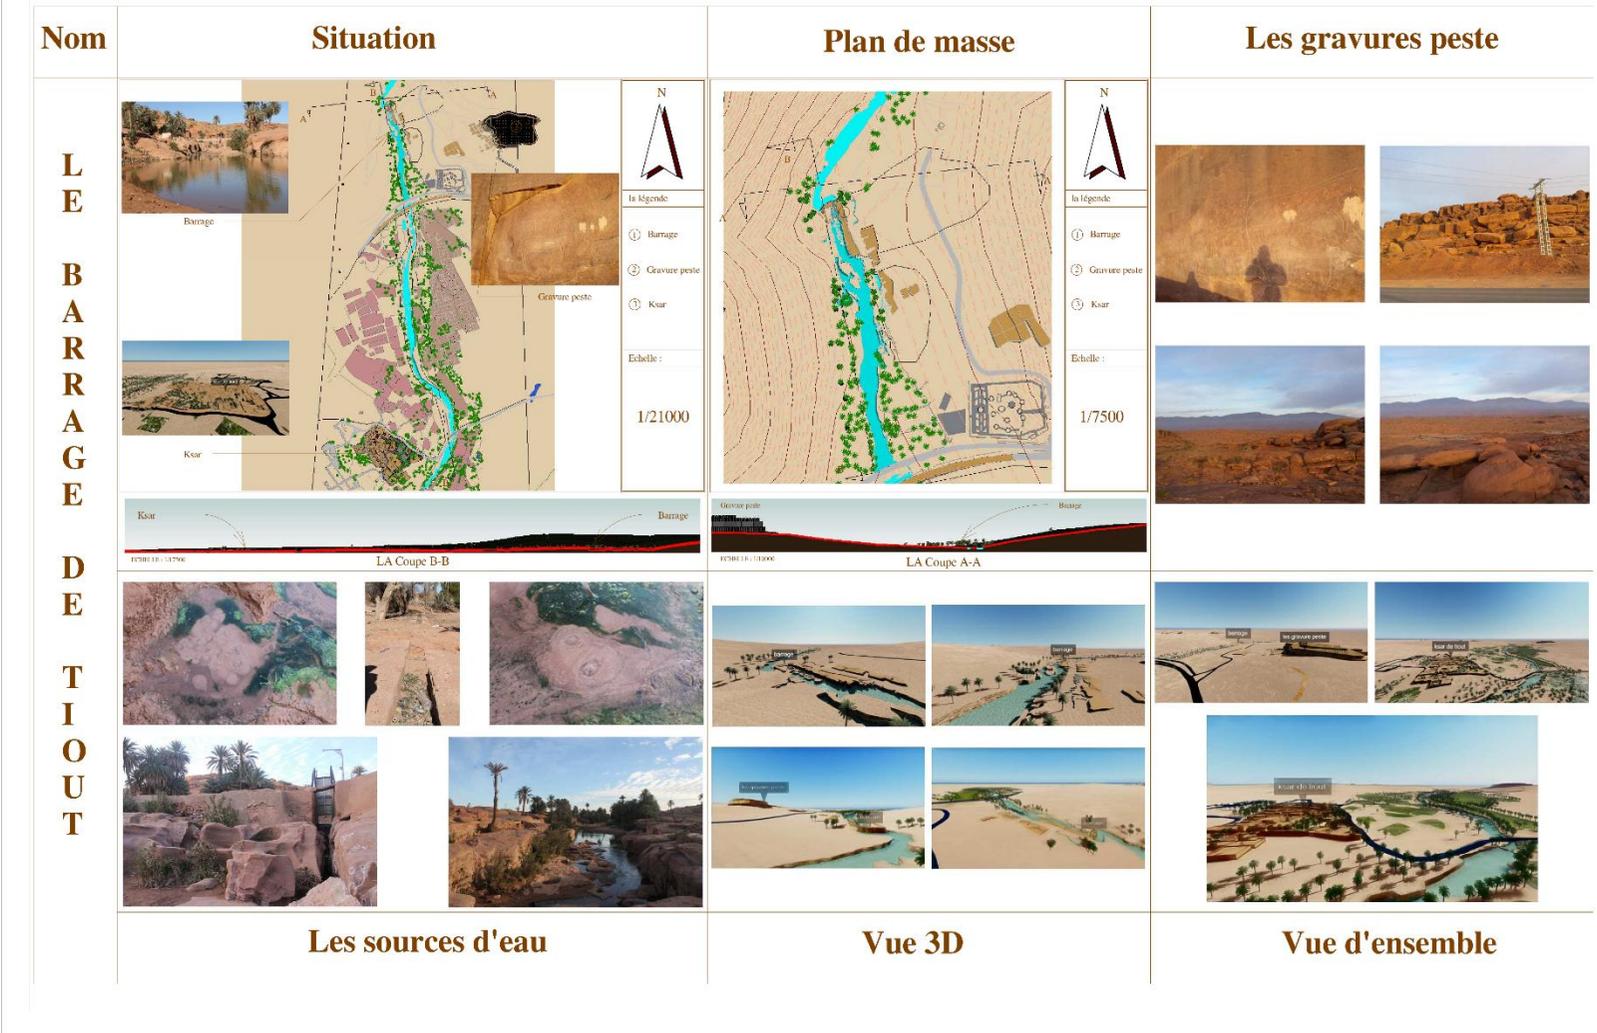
Plan, coupe et Vues en 3D du barrage ancestrale de Tiout dessiné par (Auteur, 2015)
